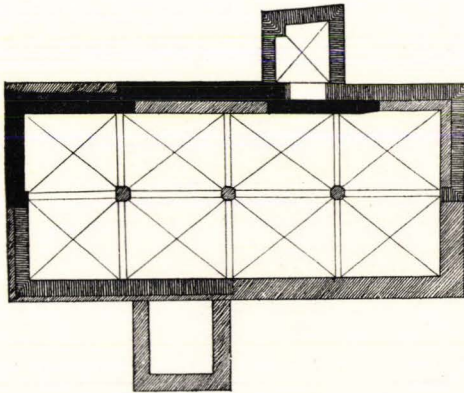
Plan av Ingå kyrka. Svart första, tvärstreckat andra, snedstreckat tredje byggnadsslaget.
